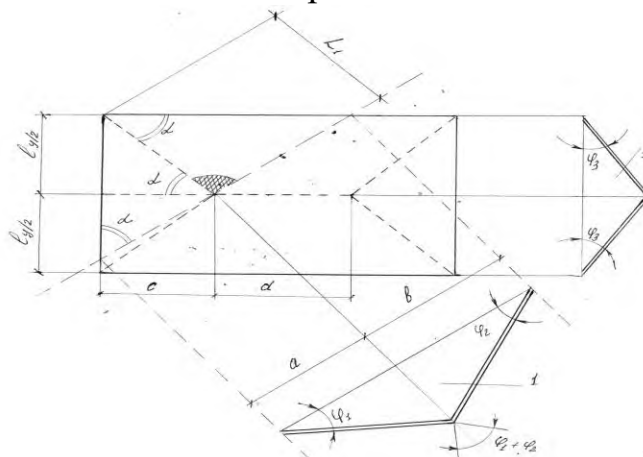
Расчет сборных железобетонных плит перекрытий,
